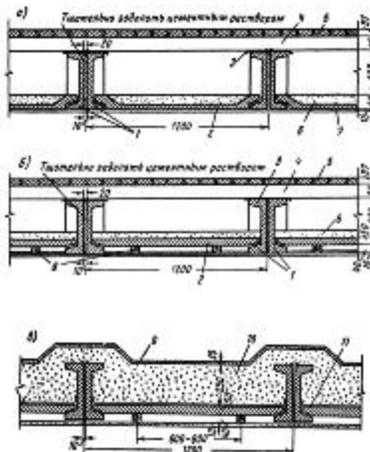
Конструкция сборного перекрытия из железобетонных швеллерных балок и плит с устройством пола.
